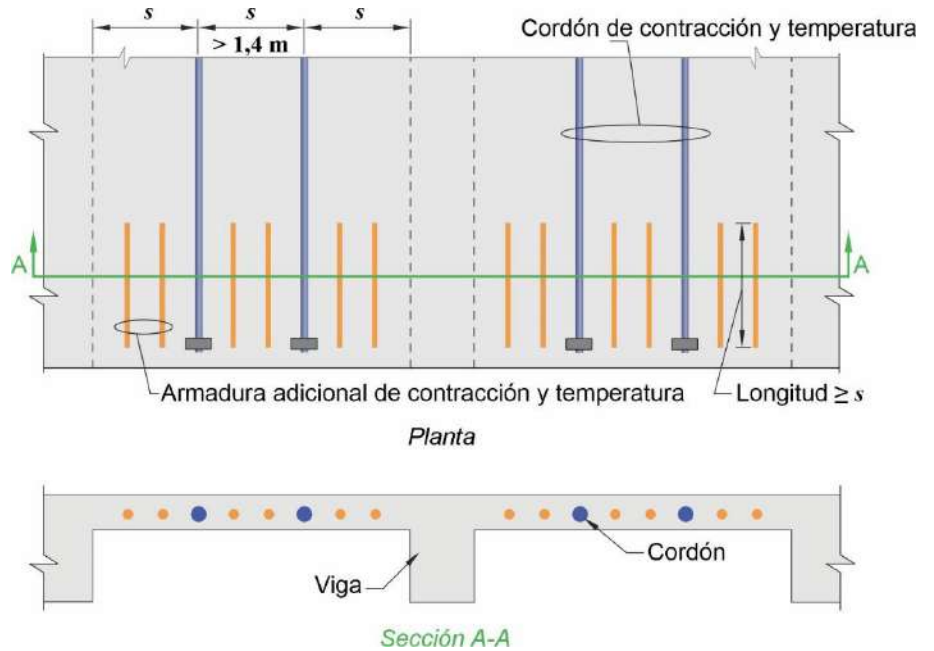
Vista en planta del borde de la losa mostrando la armadura adicional de contracción y temperatura
